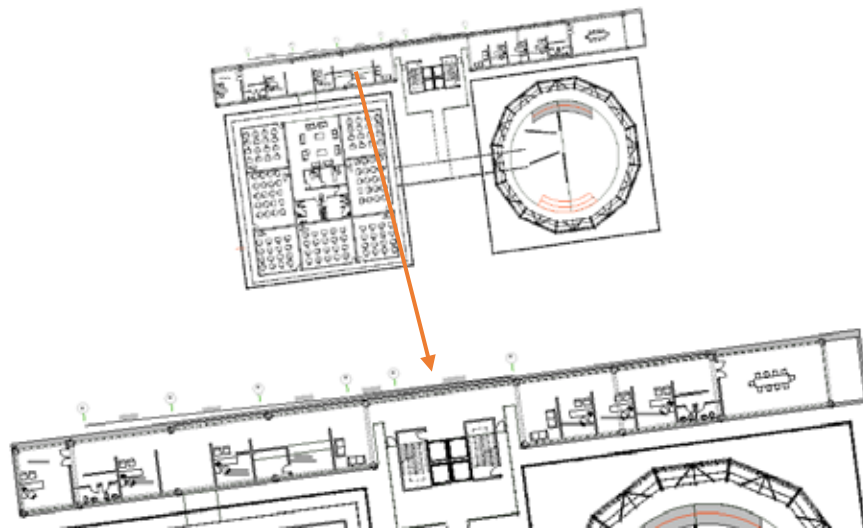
Planta 2 Nivel + 9.50 - Modulo 2. (2016)
